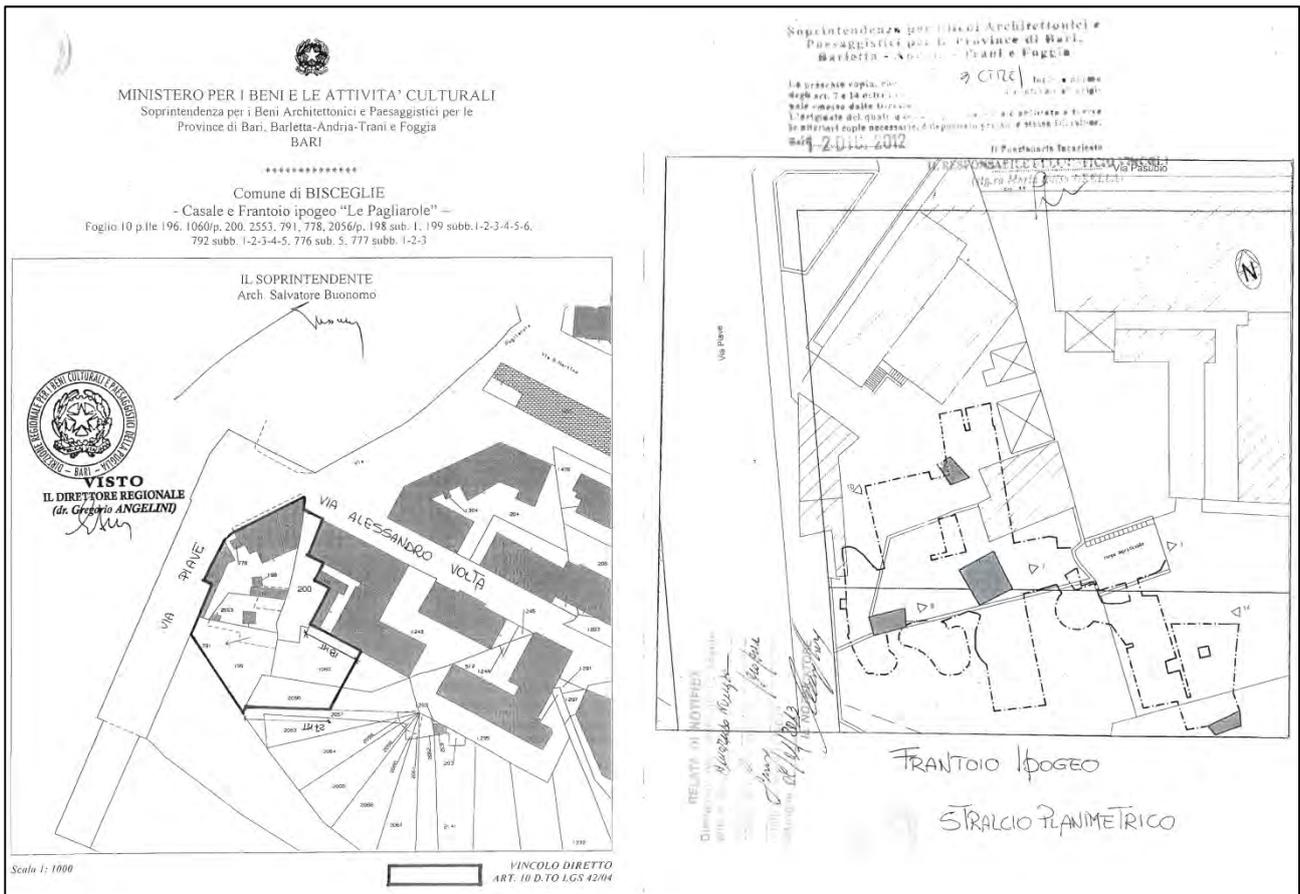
PERIMETRAZIONE AREE OGGETTO DI VINCOLO DIRETTO SU BASE CATASTALE E STRALCIO PLANIMETRICO FRANTOIO IPOGEO
